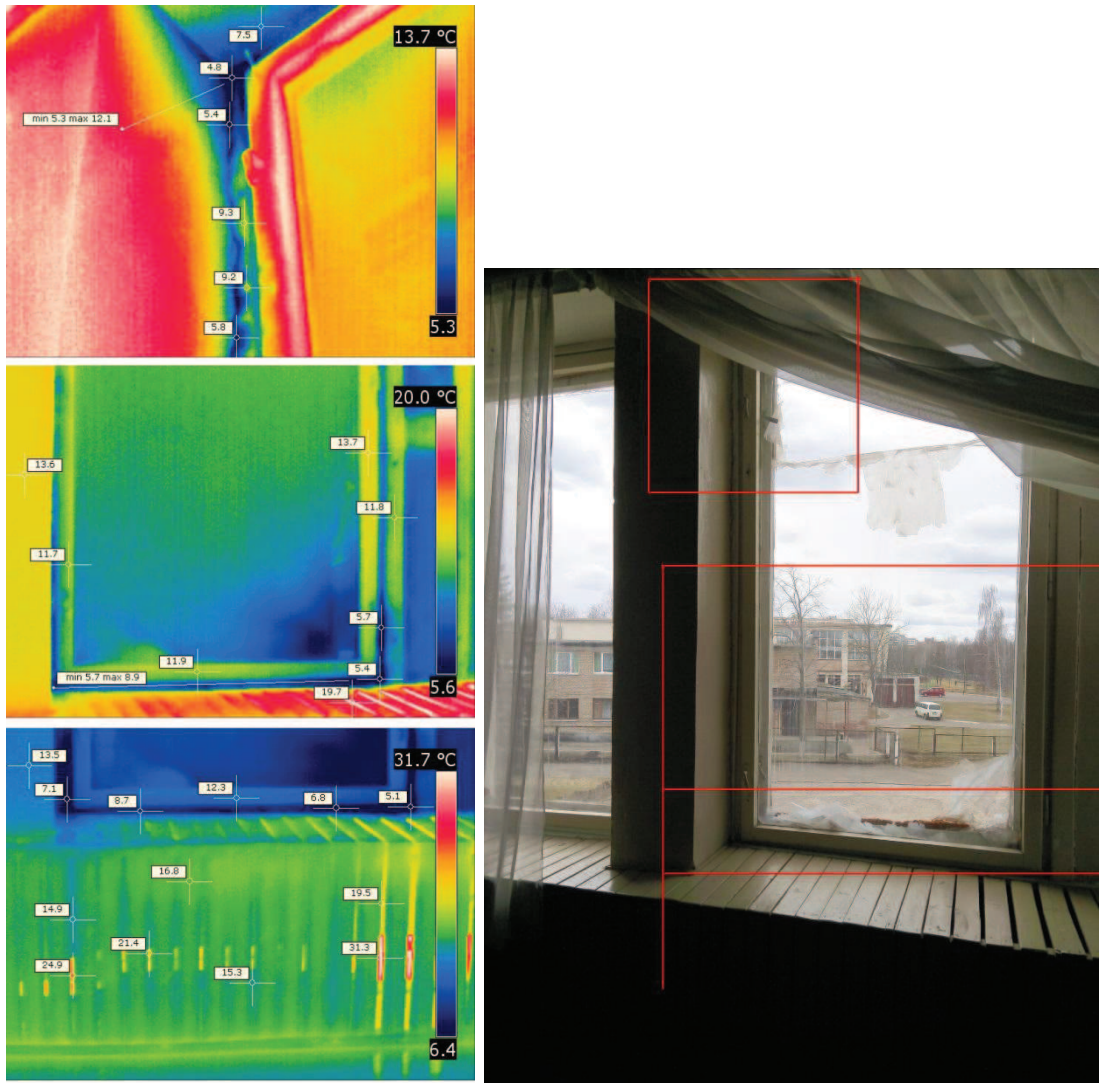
Стена помещения №211 (актовый зал), западный фасад
